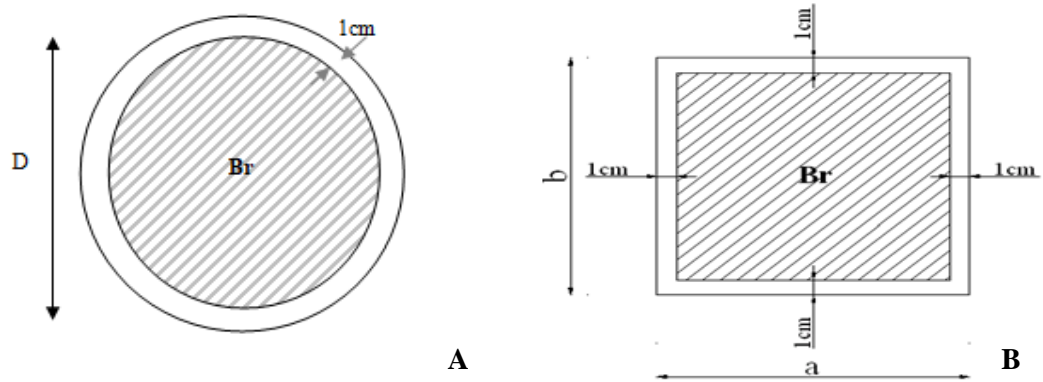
Section réduite du (A) : poteau circulaire ; (B) : poteau rectangle.
